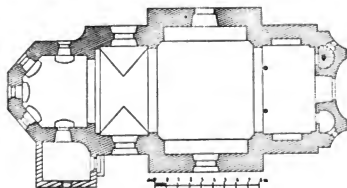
Lohowitz. Grundriss der Kirche.
